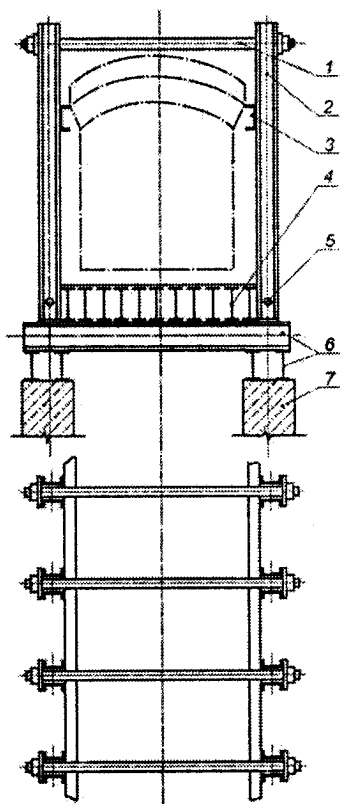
Рамний регульований каркас: 1 — верхня регульована пов'язь; 2 — стоек; 3 — підп'ятова балка; 4 — подова рама; 5 — шарнірне або жорстке кріплення; 6 — зварна рама; 7 — фундамент
